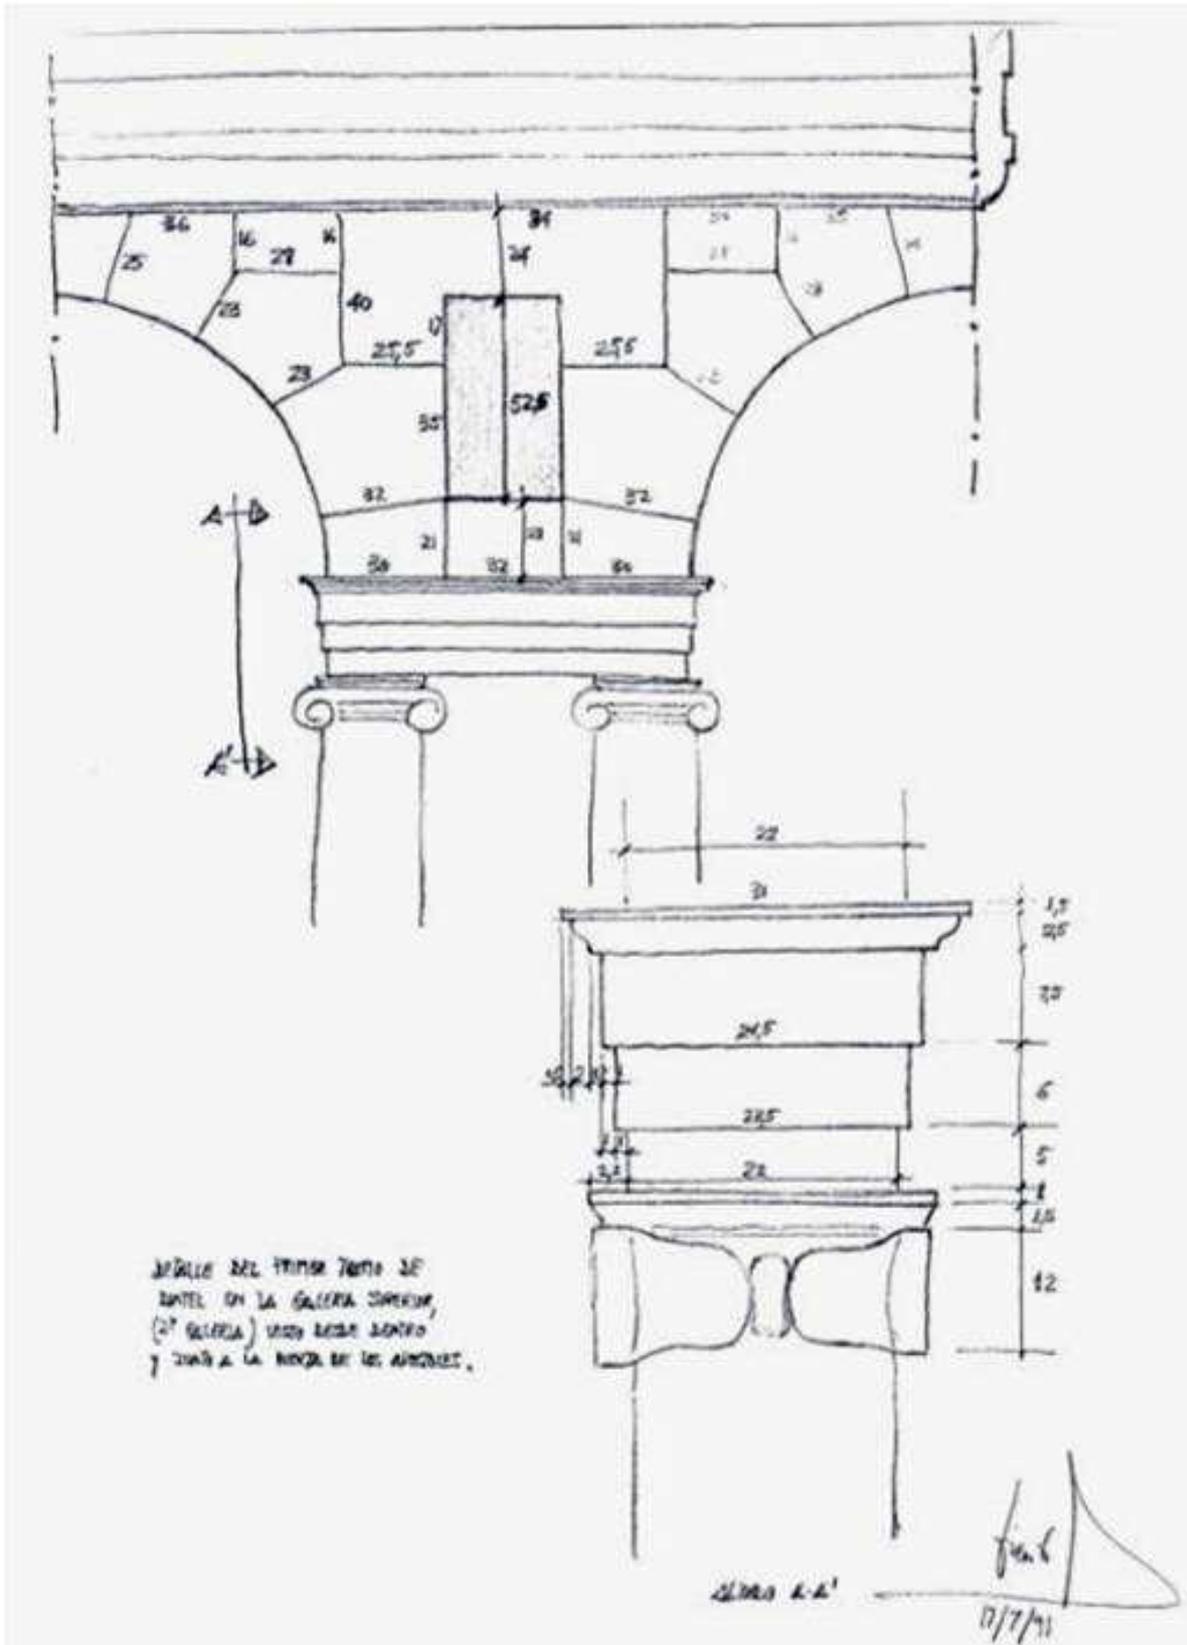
24.4 Detalle de las columnas de la última planta.
